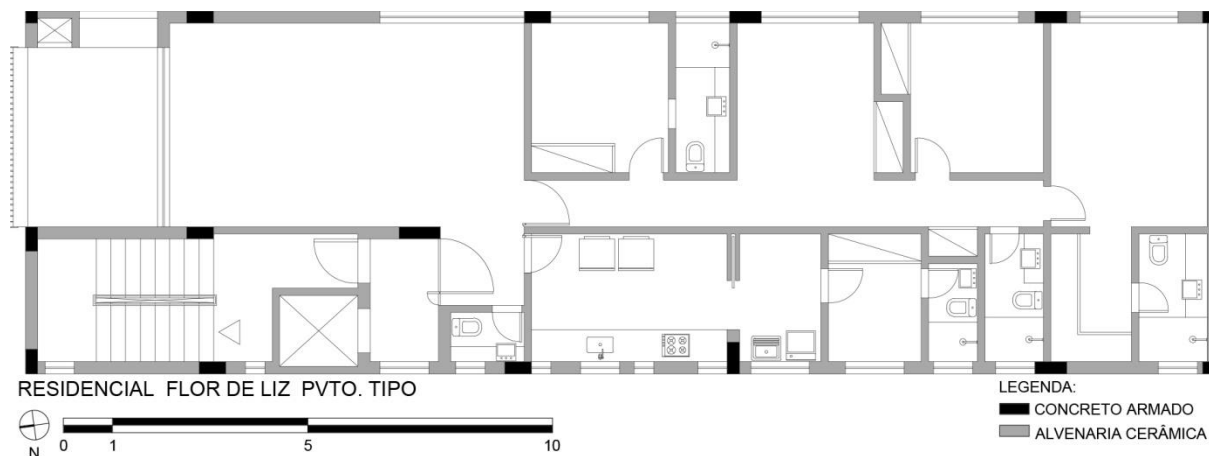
Divisórias e fechamentos do pavimento tipo do Residencial Flor de Liz
